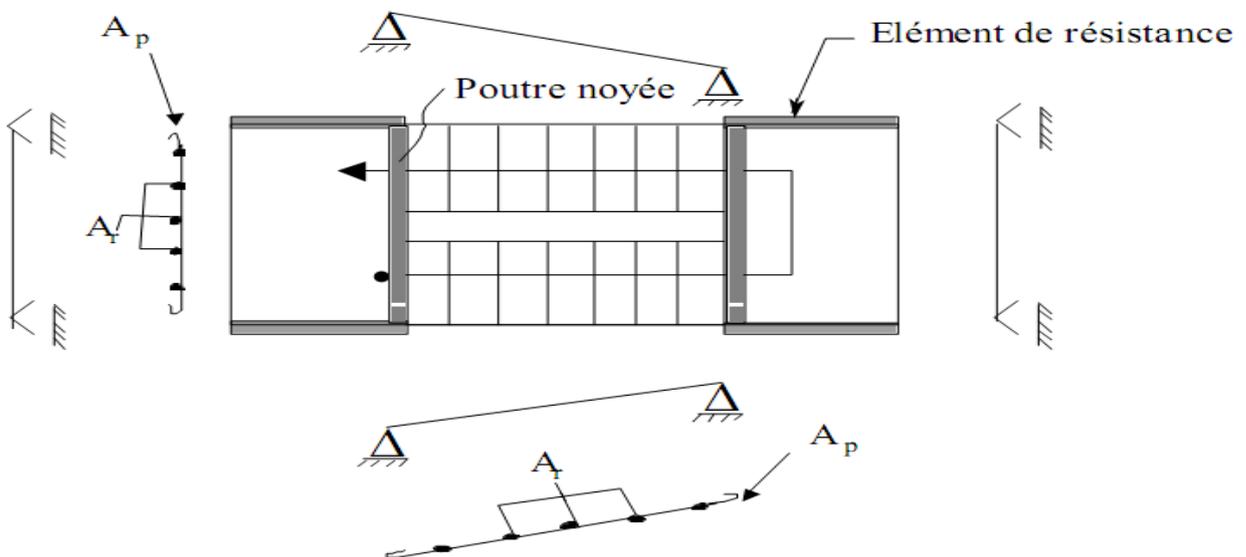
Système statique (Les paliers s'appuient dans le sens transversal).
